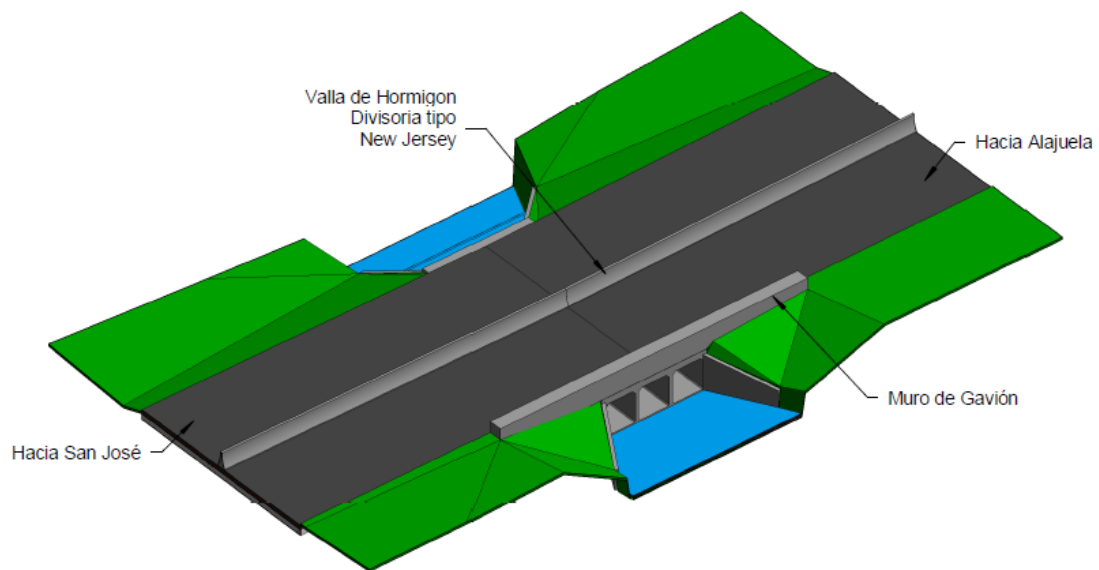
Vista tres dimensiones de la alcantarilla actual.
